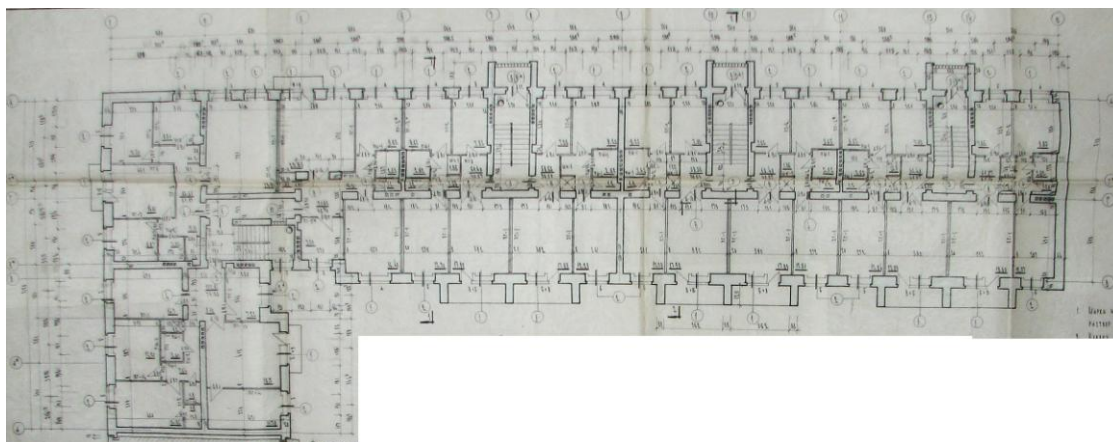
План первого этажа жилого дома серии 114-86 по ул. Ленина, д.169 – ул. Профсоюзов, д.40
